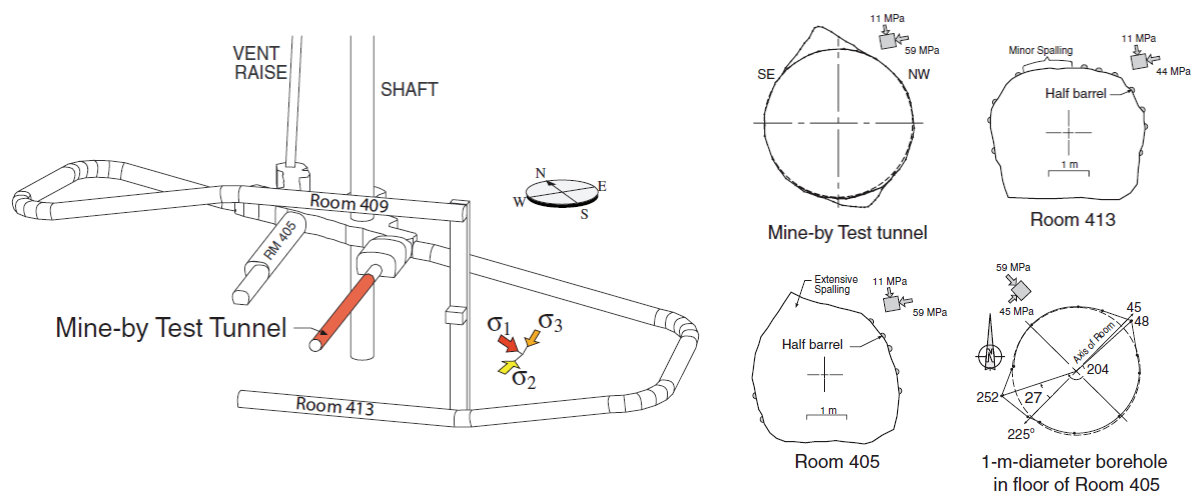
AECL's URL レイアウトおよび Spalling ¹⁵⁾
